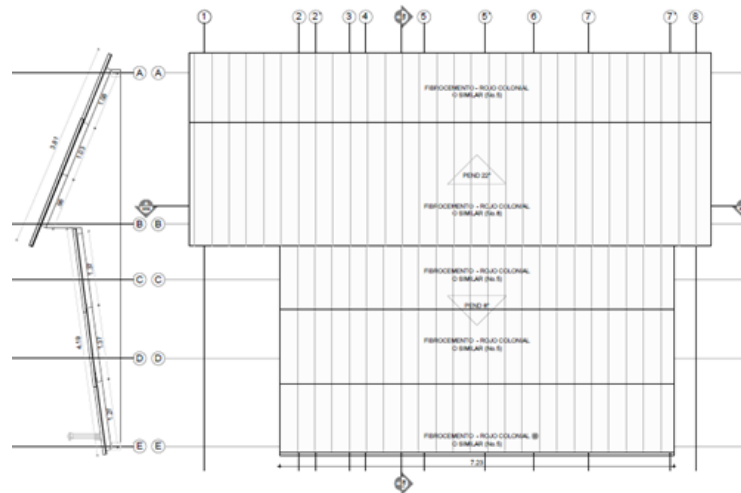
Plano de cubiertas VISR Proyecto Tipo SV-HT-001
